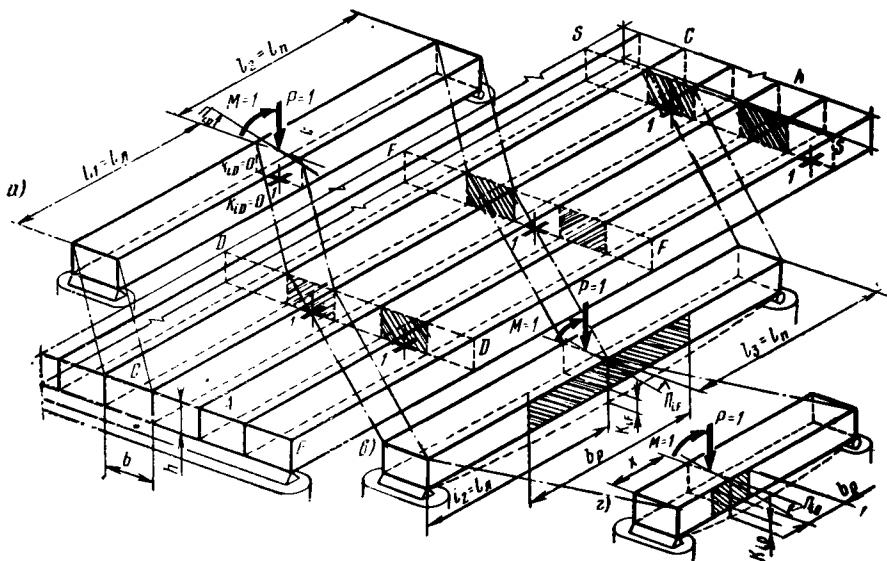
Схемы к расчету плитного пролетного строения с точечным опиранием:
